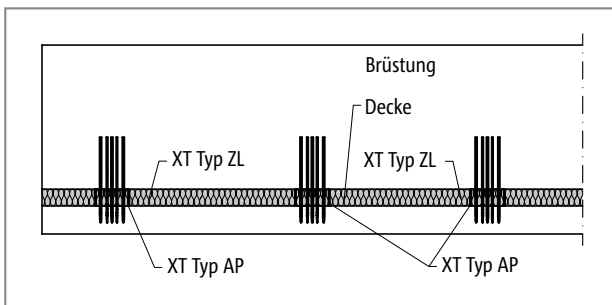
Schöck Isokorb® XT Typ AP vertikale Anordnung: Ansicht Brüstung aufgesetzt
